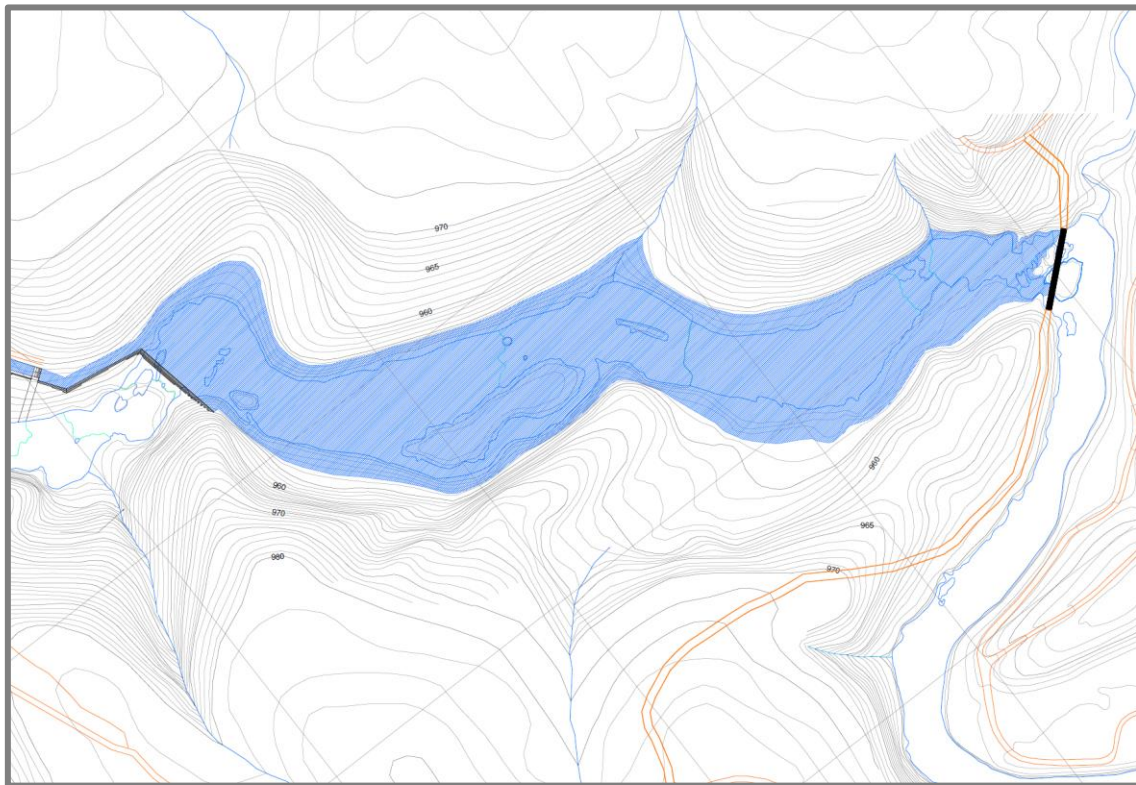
Planta do reservatório da PCH Pulo El.953,60 m
